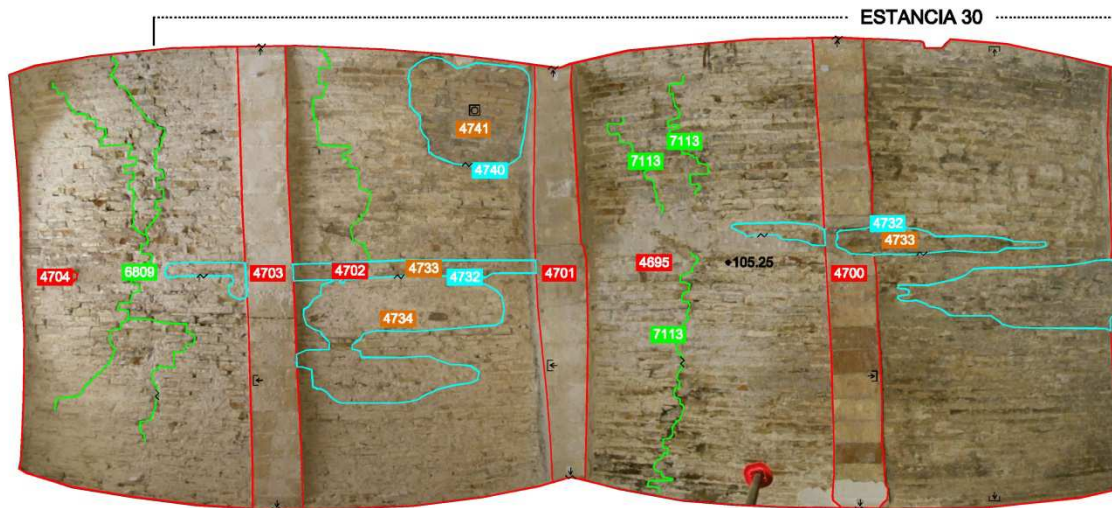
Sistema de agrietamiento en la planimetría de análisis estratigráfico de bóvedas en el Pósito de Córdoba. Las grietas aparecen en verde (Convenio UCO-GMU)
